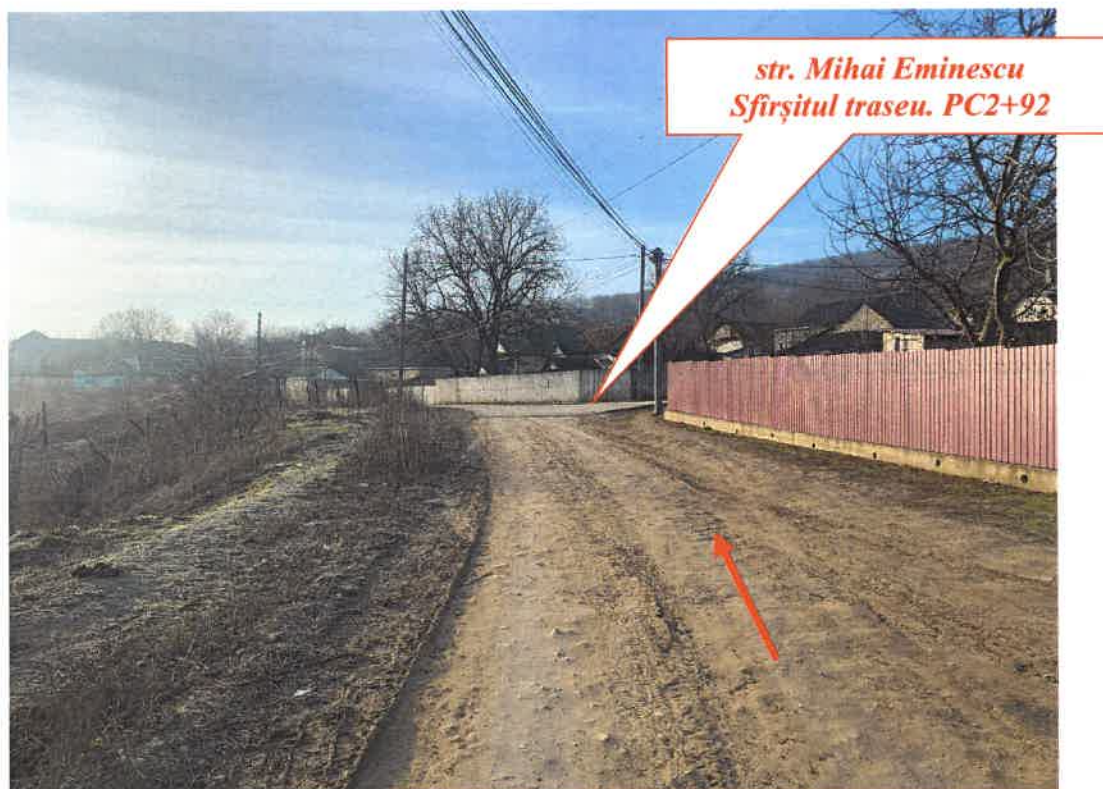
Situatia existanta la PC2+92 (Sfirșitul traseu) marginea î.r. din beton monolit
